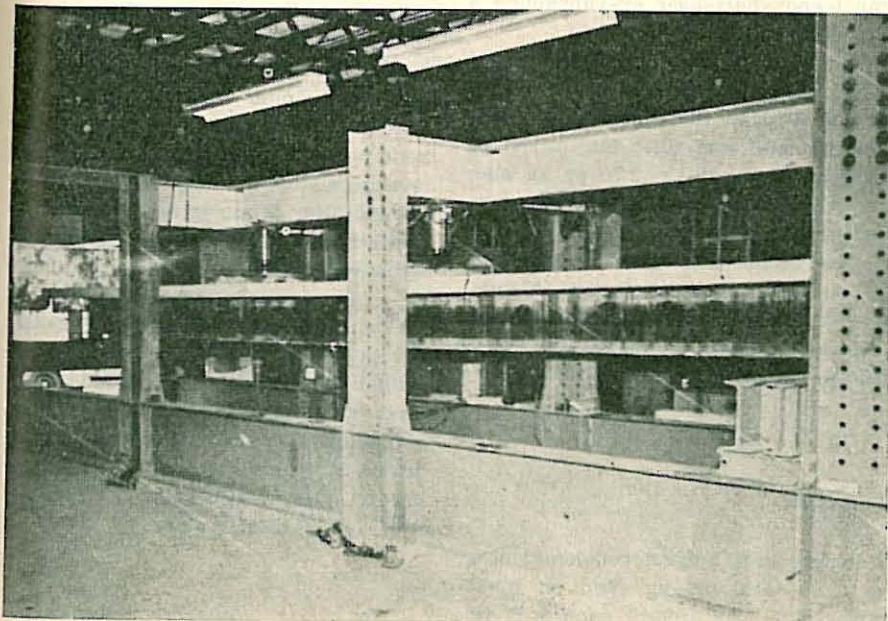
Prøvning av betongbjelke sammenføyet med plastmørtel.
